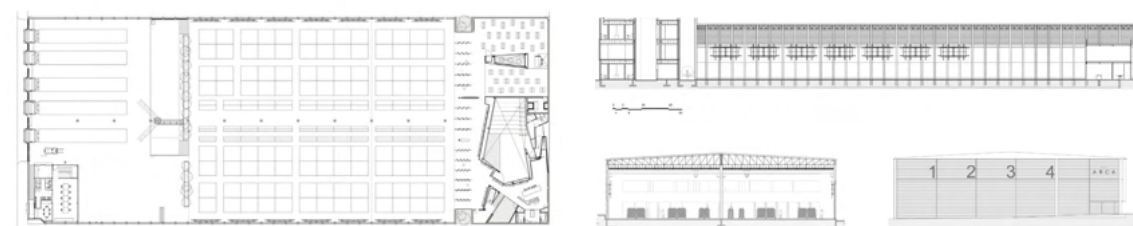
Planta do nível 1 ou piso térreo do complexo
